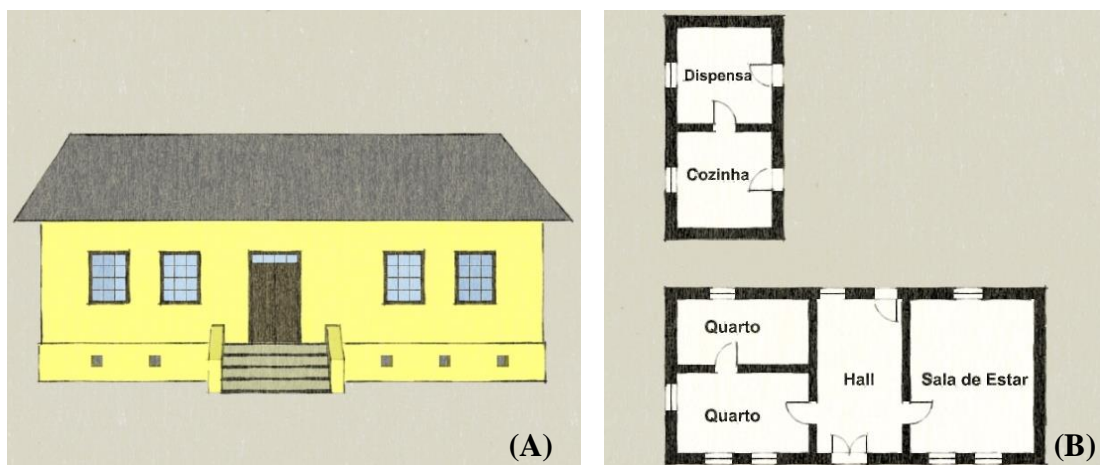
a) Fachada principal tipo 1; b) Planta baixa tipo 1
